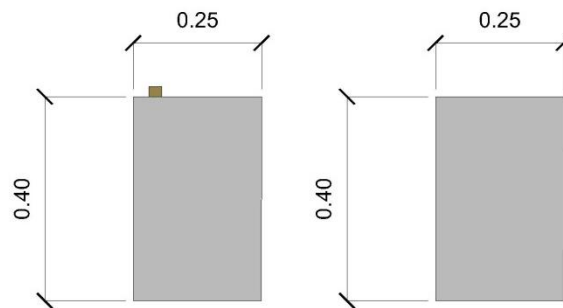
Alçados transversais da Viga A e da Viga B (dimensões em m)
